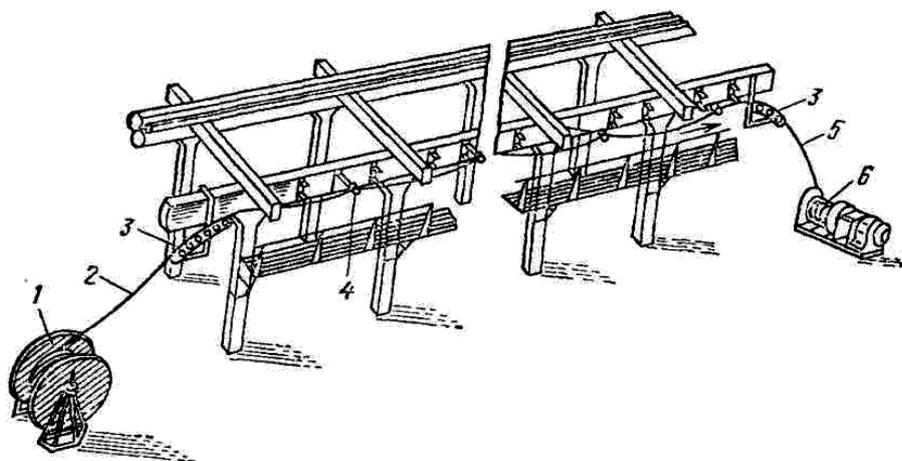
Раскладка кабеля на открытых эстакадах тяжением электролебедкой: 1 – барабан с кабелем; 2 – кабель; 3 – угловой ролик; 4 – линейный ролик; 5 – канат; 6 – лебедка
